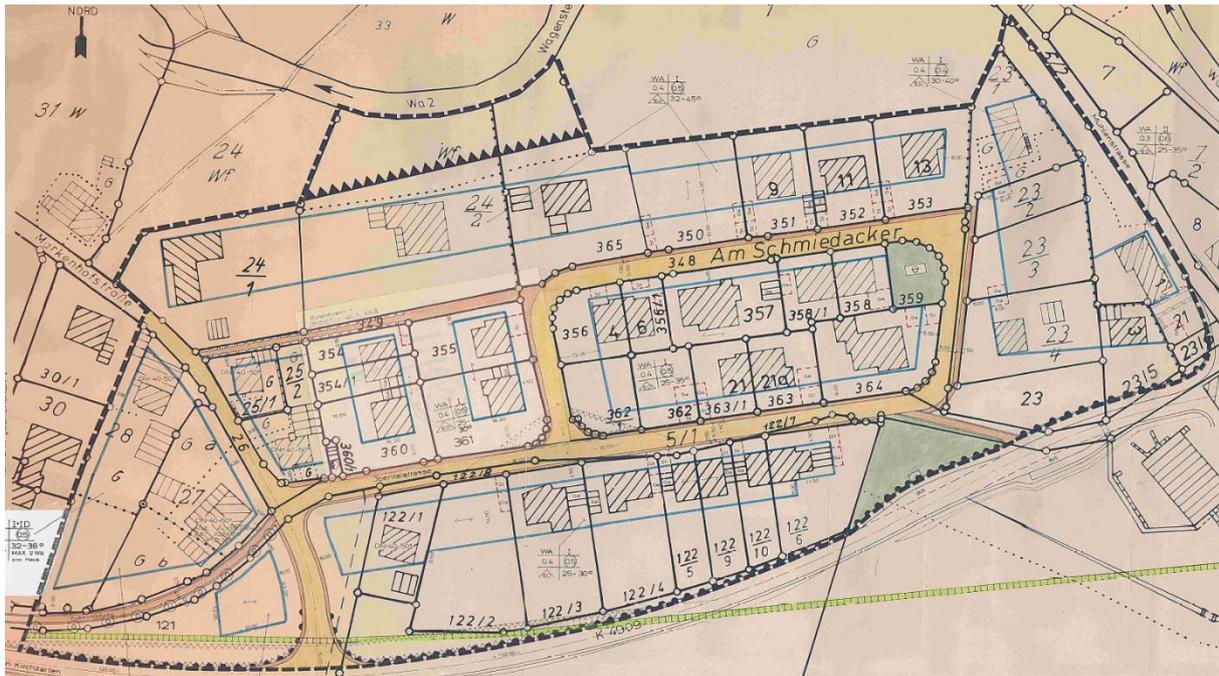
Planzeichnung zum ursprünglichen Bebauungsplan „Bühlacker II“.
